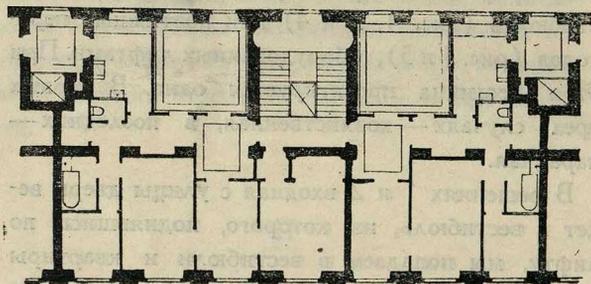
Планировка многоэтажного дома с квартирами, имеющими 2 выхода при одной лестнице (переработка решения мастерской арх. Б. Иофана)
